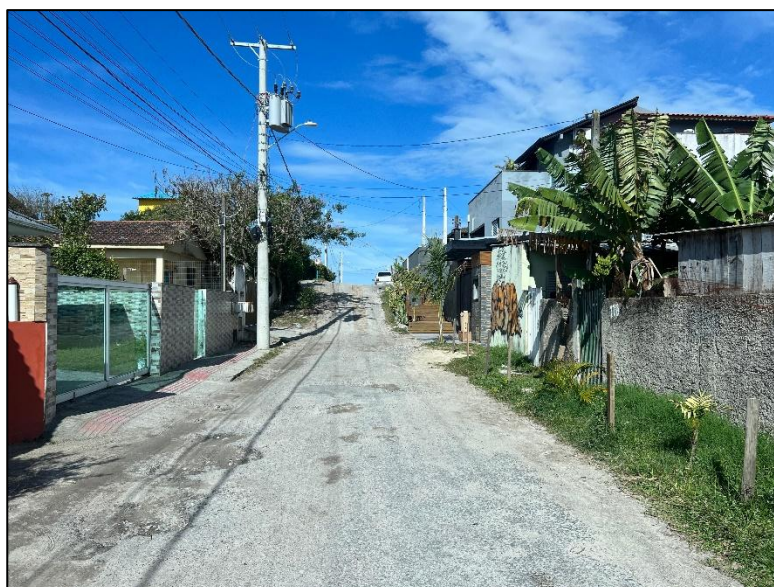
Trecho intermediário da Rua das Corujas, em aclive, com segmento pontual de pavimentação em concreto.
